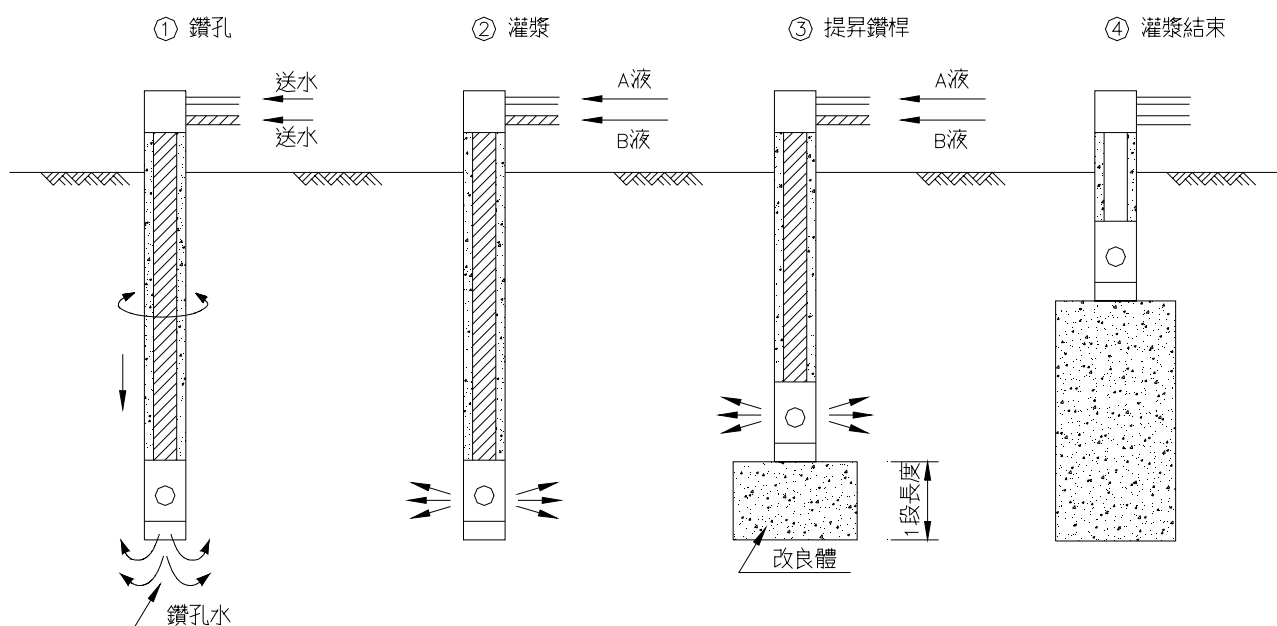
雙重管灌漿工法(單相式多孔管)施工示意圖
